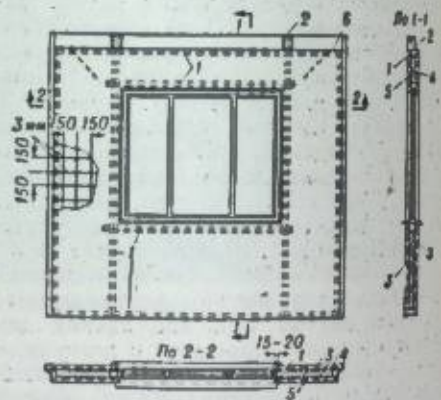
Трехслойная панель наружной стены: 1 — армирующие сварные каркасы; 2 — подъемные петли; 3 — тяжелый бетон; 4 — утеплитель; 5 — сварные сетки; 6 — закладные детали.
